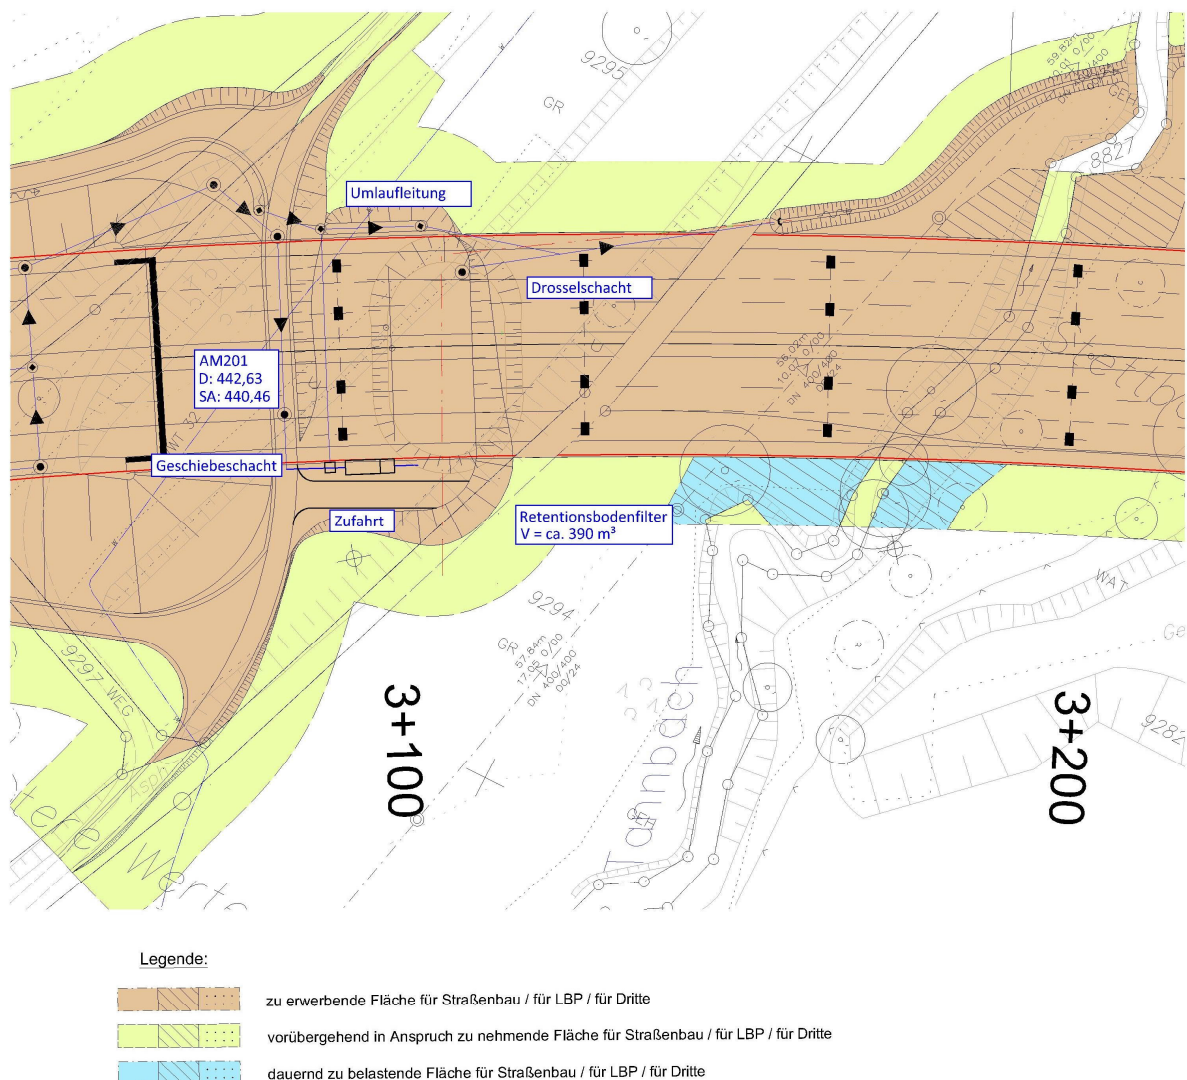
Entwässerungsabschnitt 1B. Grundriss Retentionsbodenfilteranlage. Ohne Maßstab
